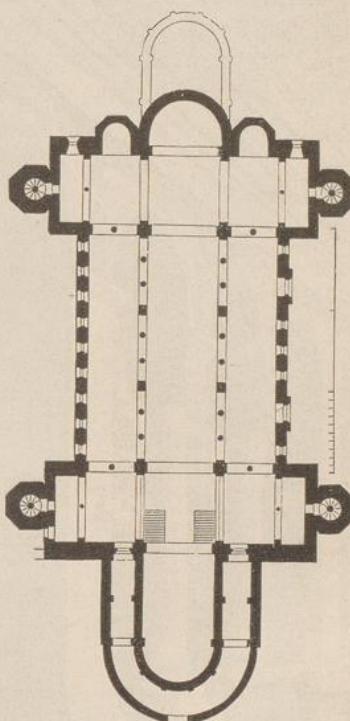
Grundriss von St. Michael zu Hildesheim.
